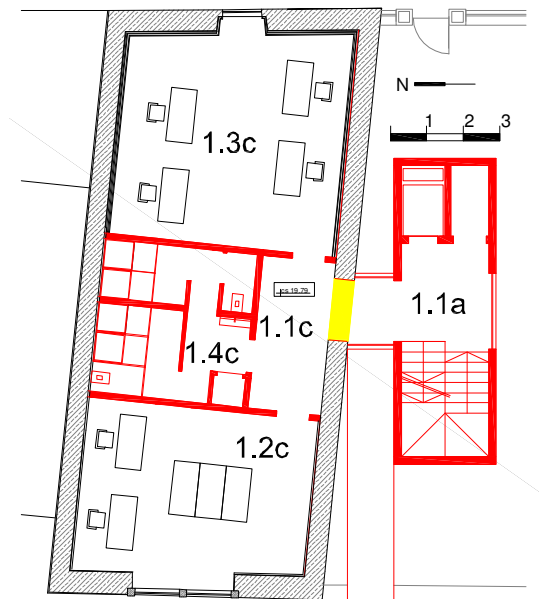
Cocheiras: Planta do Piso 1 com as Cores Convencionais
